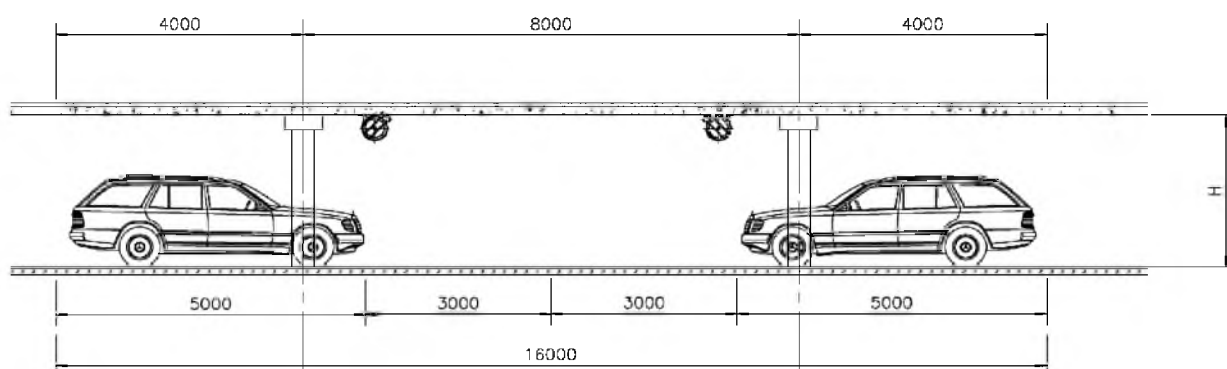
Монтаж струйных вентиляторов над дорожным полотном, рядом с колоннами.
